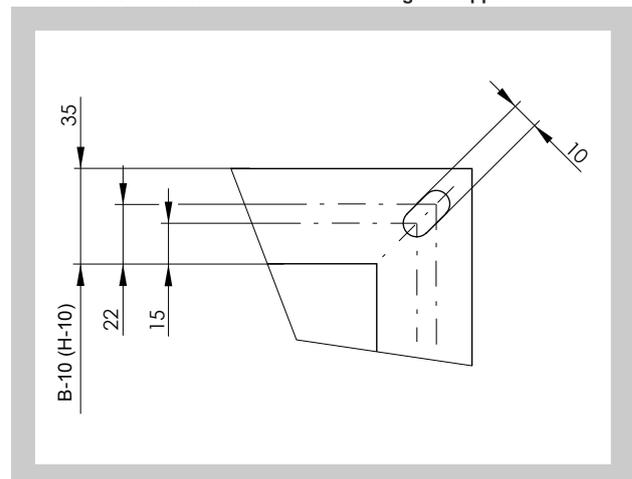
Flanschanschluss der eckigen Klappe – Einbauseite
